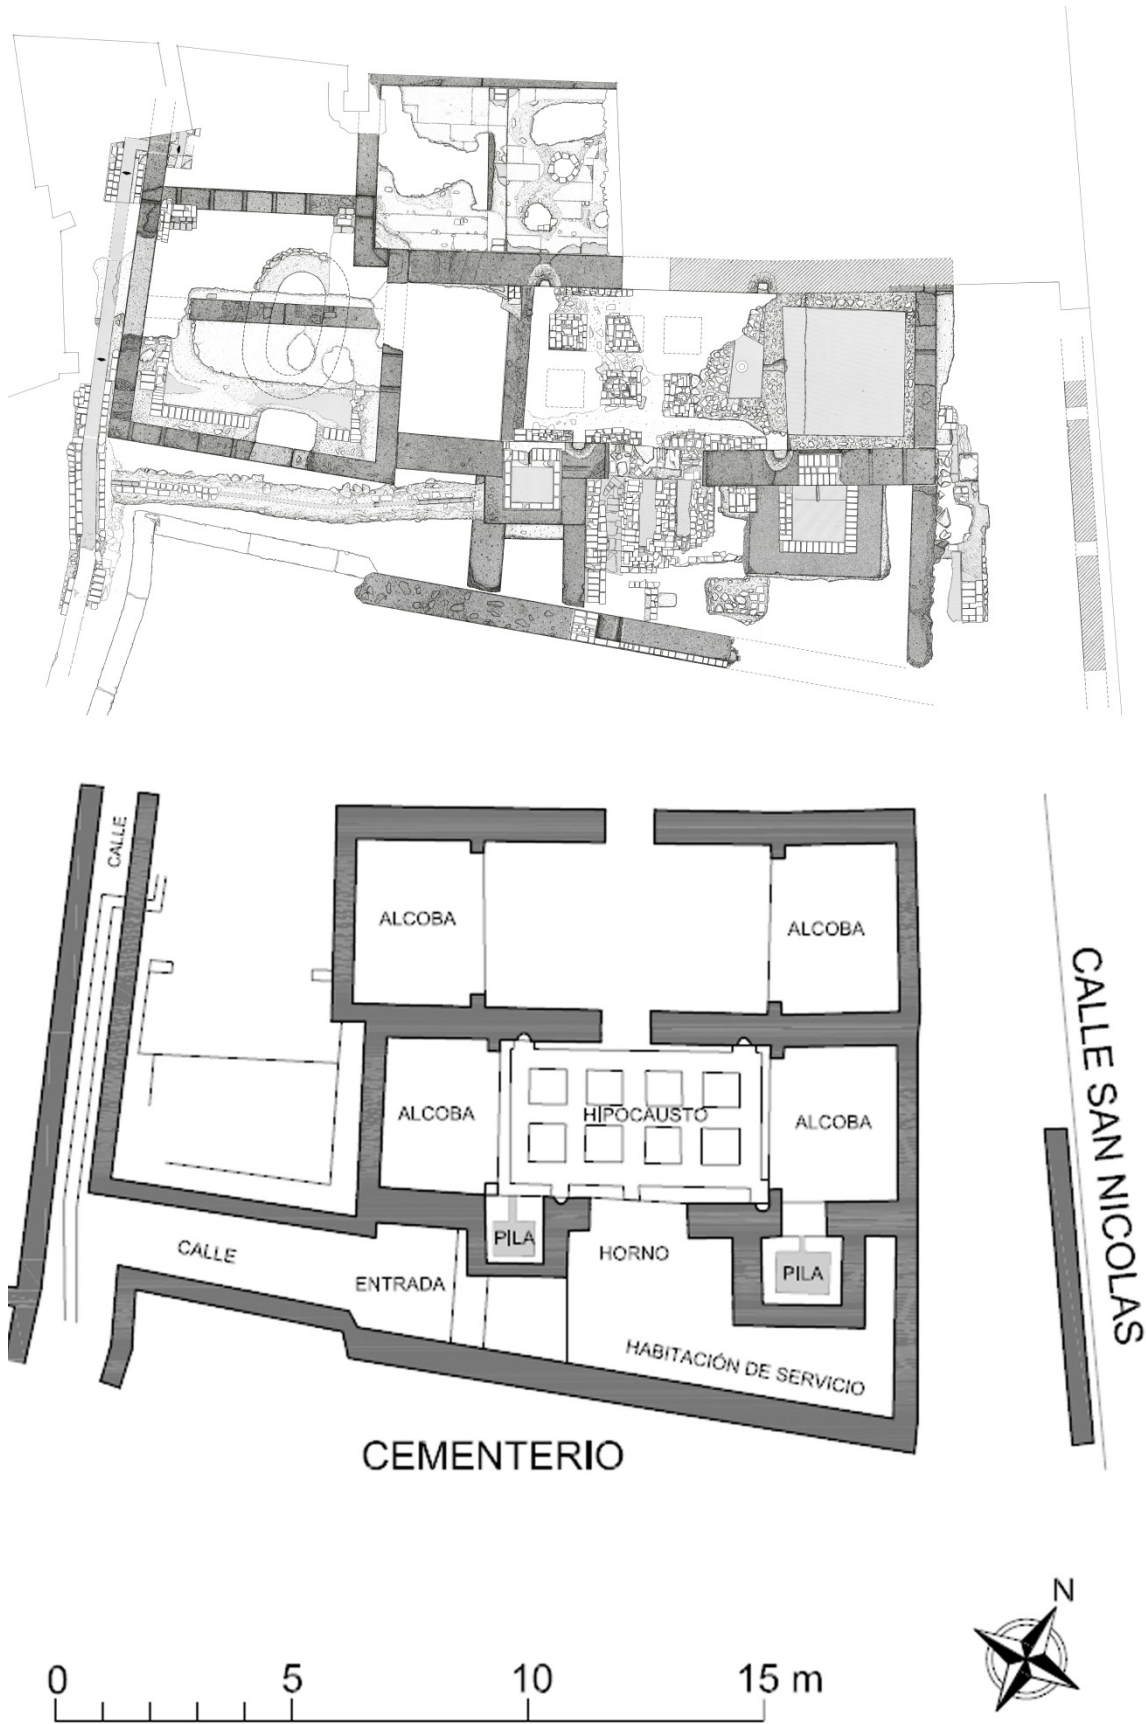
Baño de San Nicolás. Planta arqueológica y croquis
